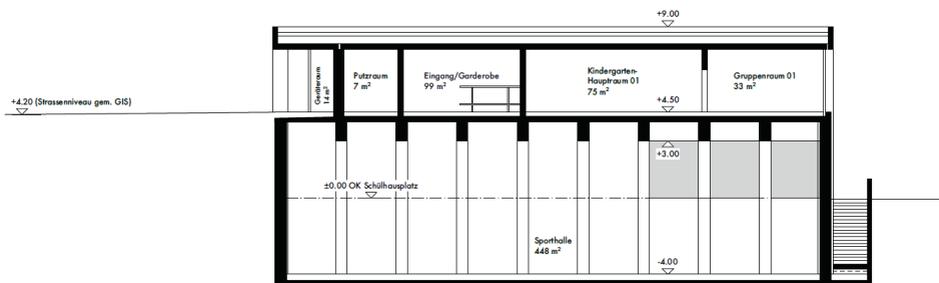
Längsschnitt Doppelkindergarten mit Sporthalle
